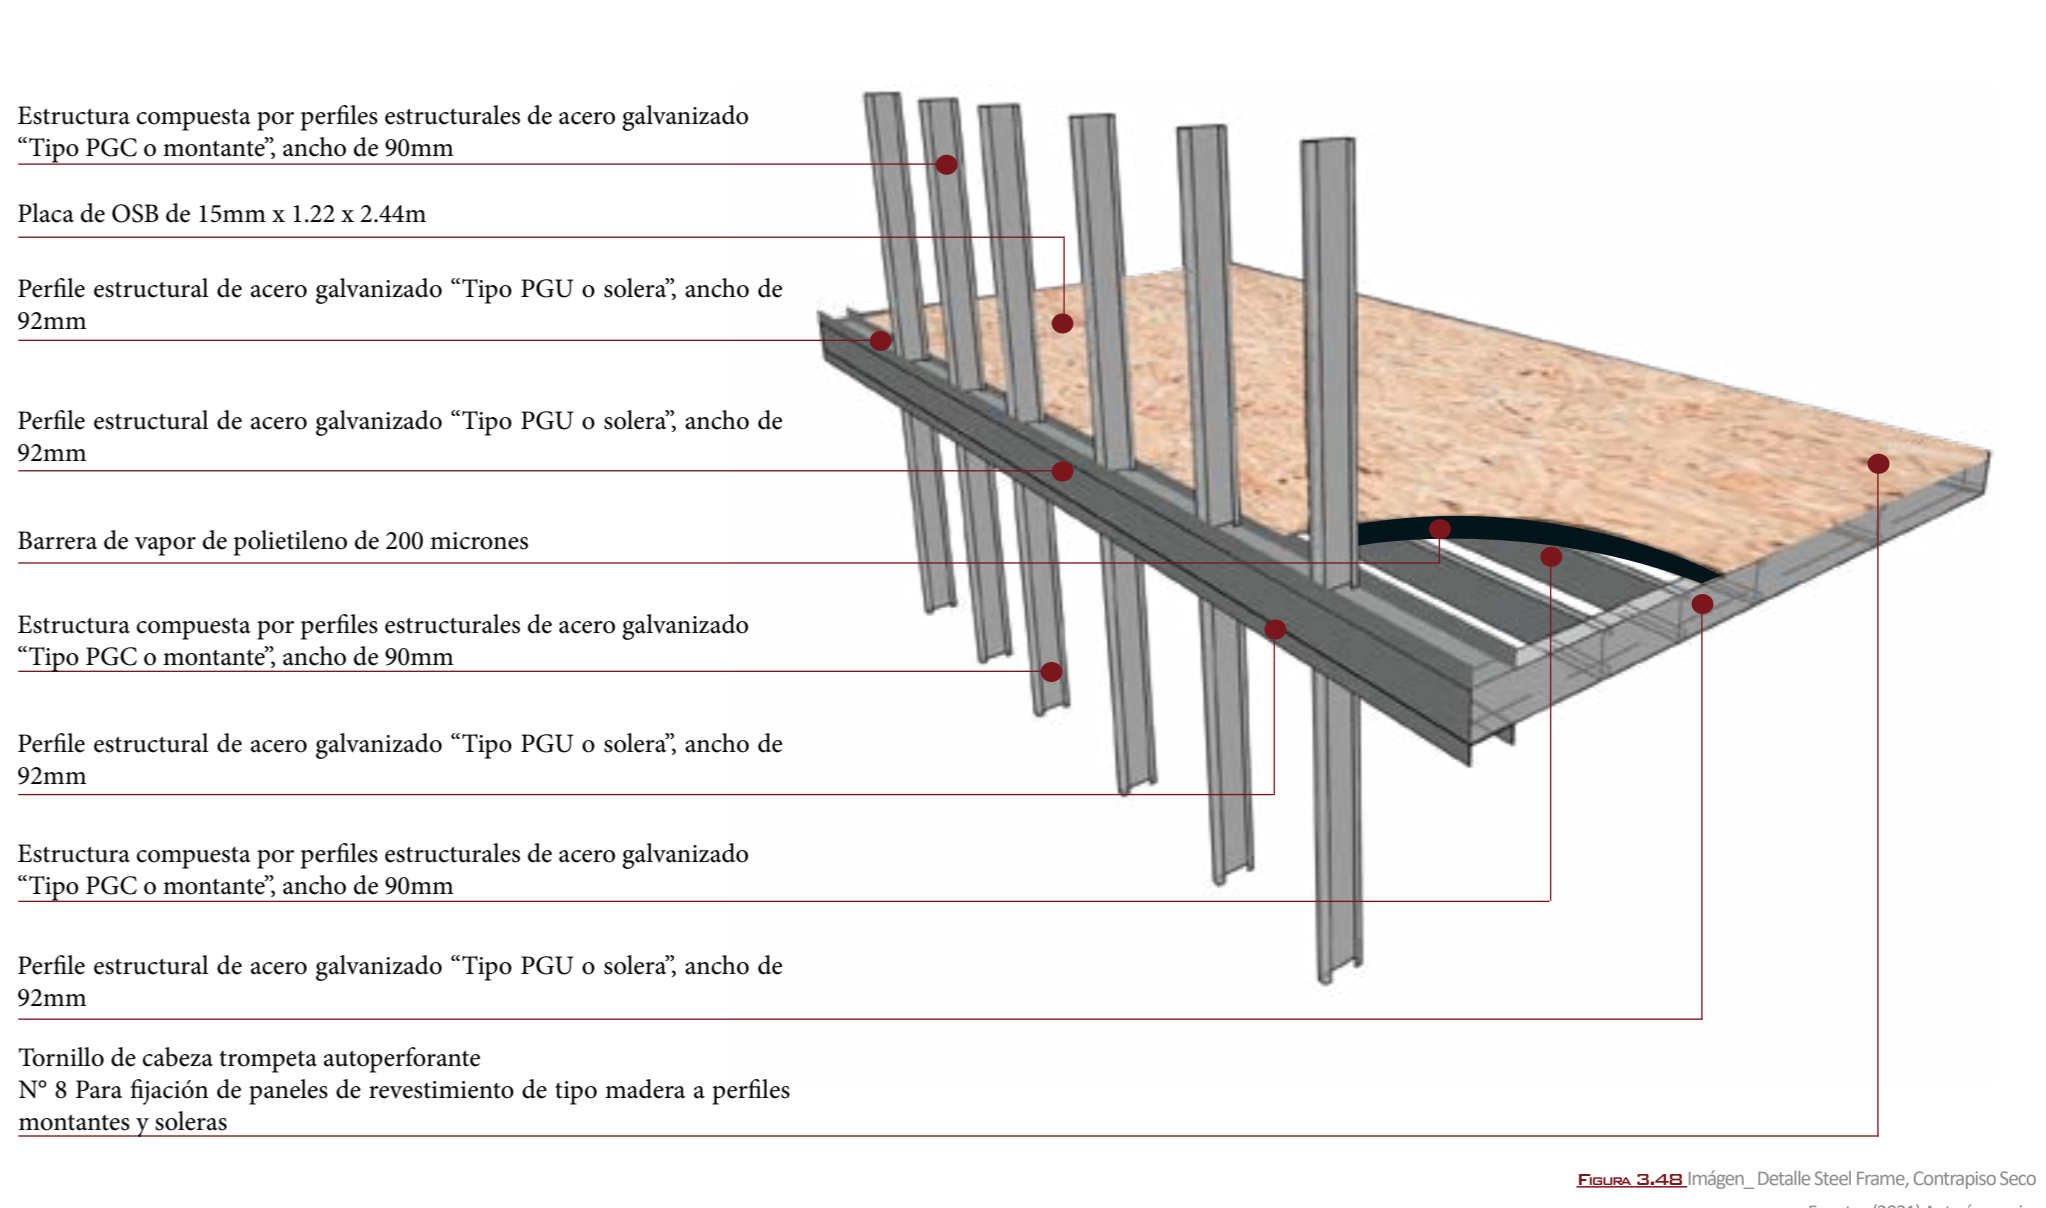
Imágen_Detalle Steel Frame, Contrapiso Seco
